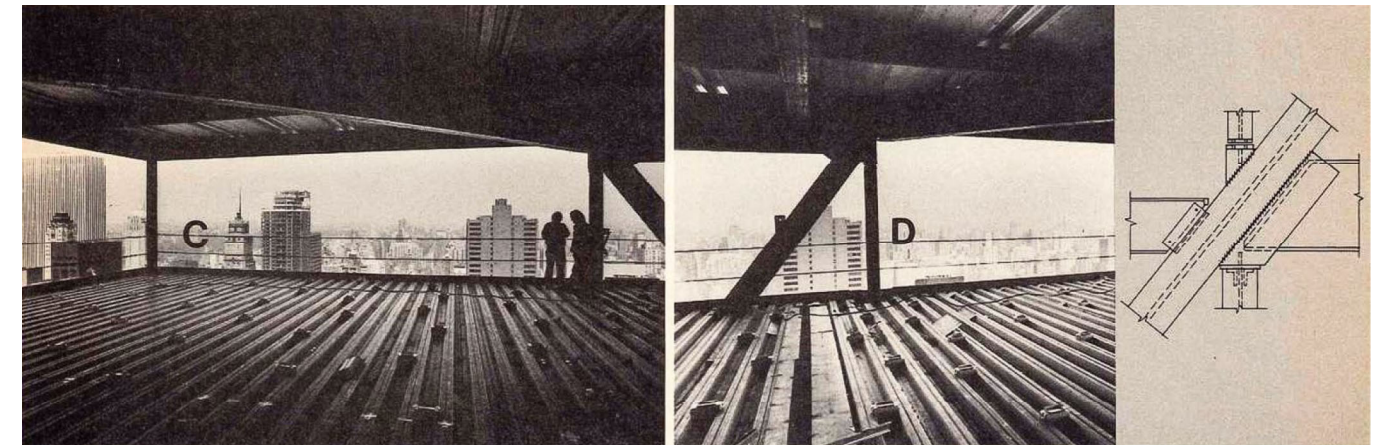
Vistas interiores del perímetro de la torre Citicorp, detalles C y D de la figura 10. Se adjunta a la derecha un detalle estructural de la unión de los soportes intermedios con las diagonales en la cuarta planta de los módulos.
